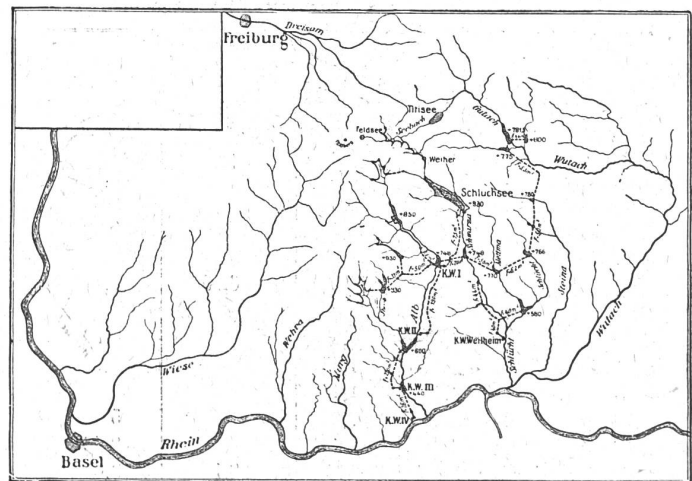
Übersichtslageplan - Entwurf „Seenkranz“.
